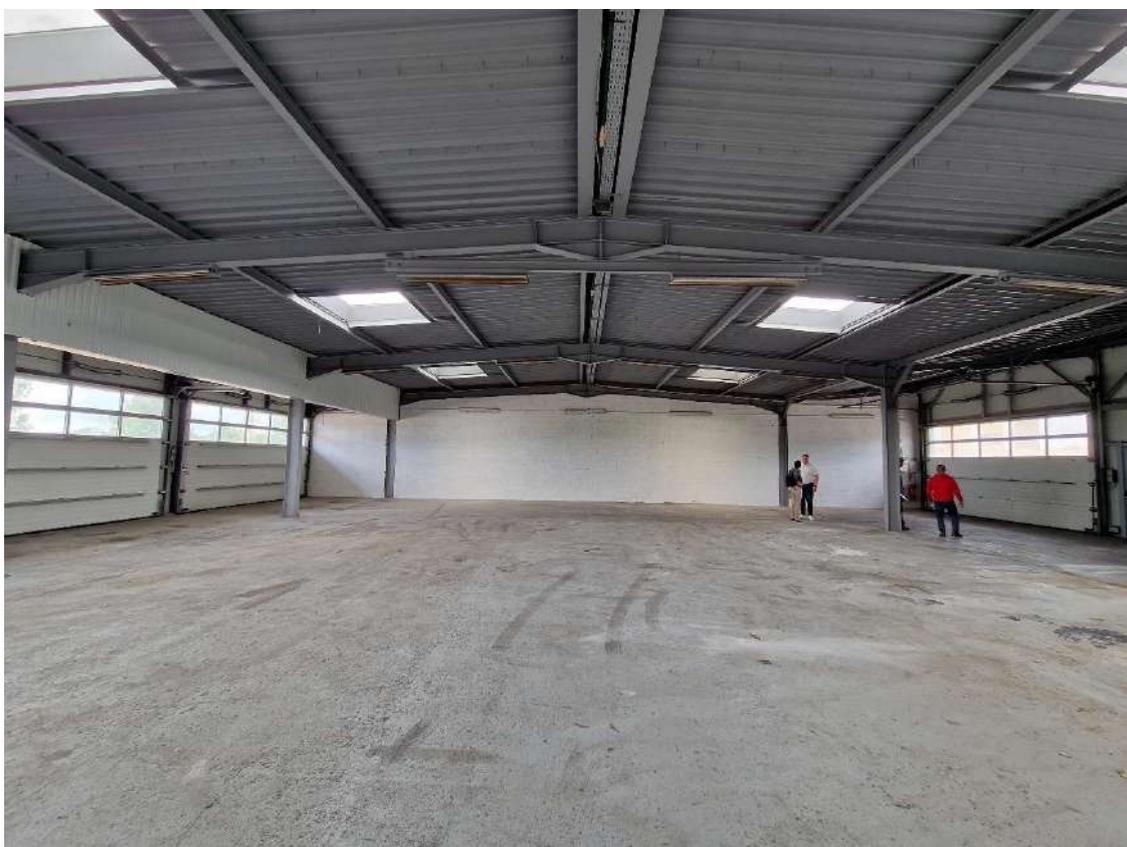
Lot 3 / Dépôt stockage + porte sectionnelle automatique sur face EST / 18m x 23m ≈ 414m²
